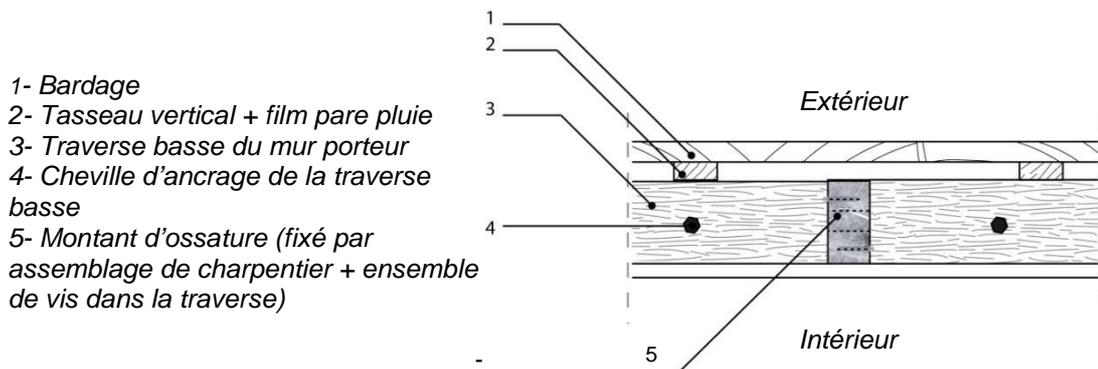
Coupe horizontale sur montants d'un panneau courant secondaire avec assemblages de charpentier
